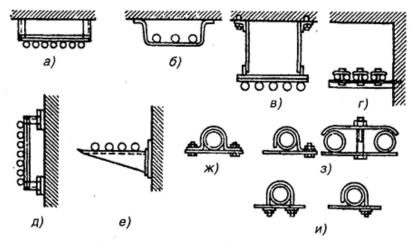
Способы крепления труб к опорным конструкциям:
